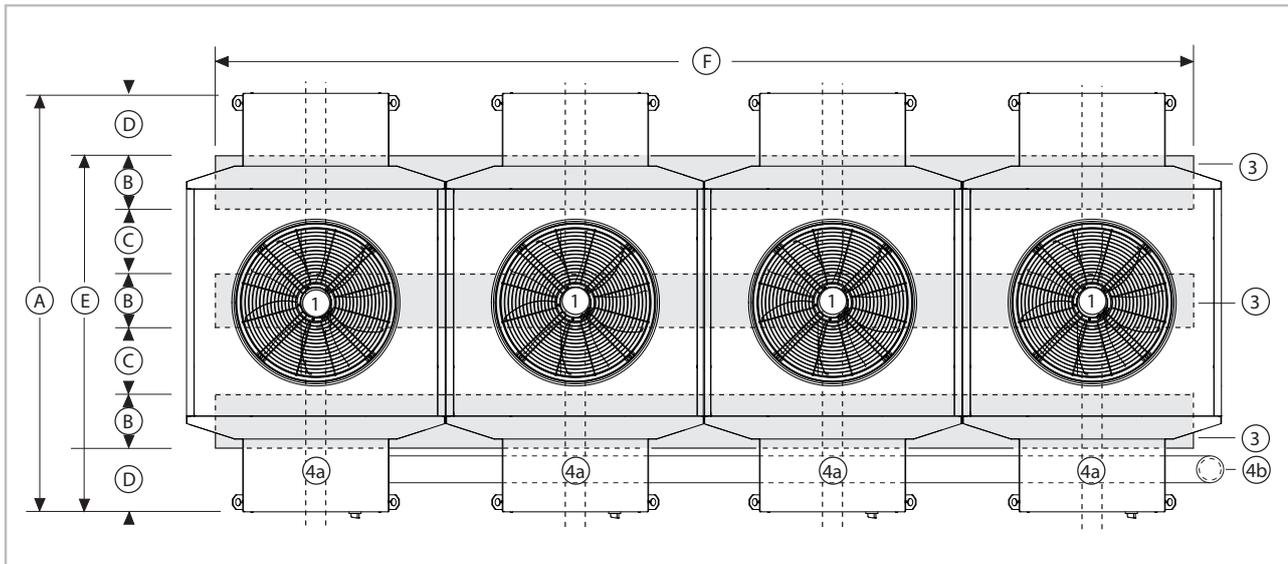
Dimensions des semelles filantes (vue de dessus)
